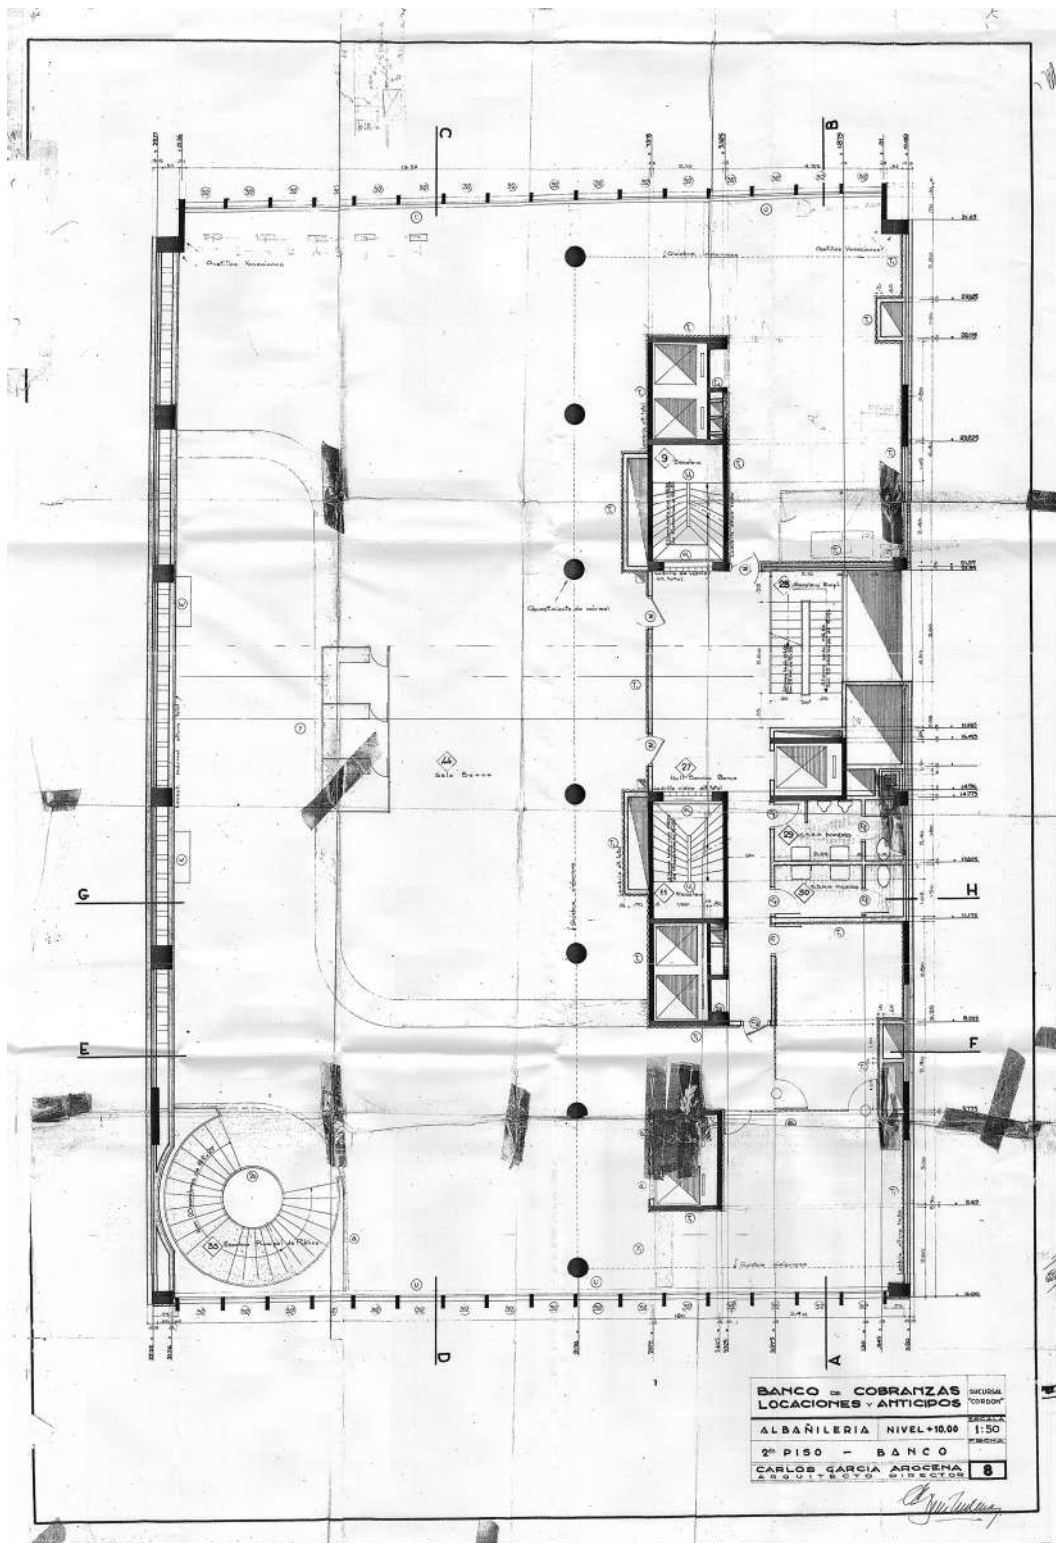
Lámina 8 del proyecto ejecutivo del BCLA: planta del piso 2.
